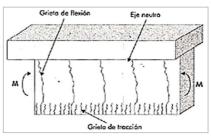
Fisuras por Flexión Pura Fuente: Investigación
